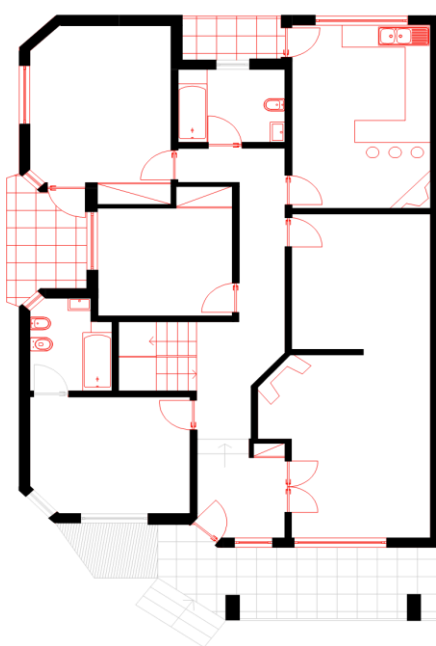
Planta do piso R/C - Existente. Fonte: autor
